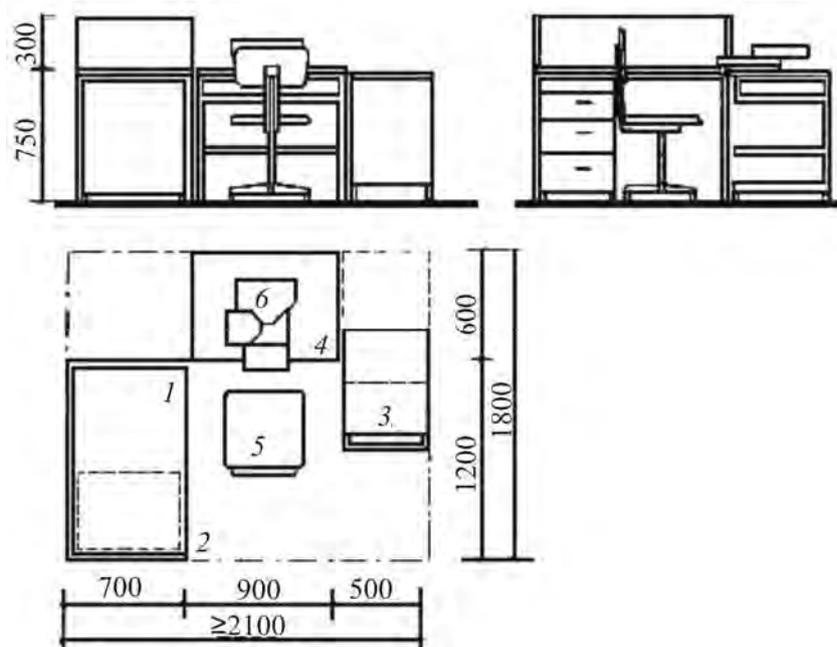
Рабочее место сотрудника кассы пересчета монет: 1 — рабочий стол; 2 — тумба; 3 — закрытая тележка (передвижной сейф) для транспортировки ценностей; 4 — стол; 5 — стул рабочий подъемно-поворотный; 6 — машина для счета и сортировки монет
